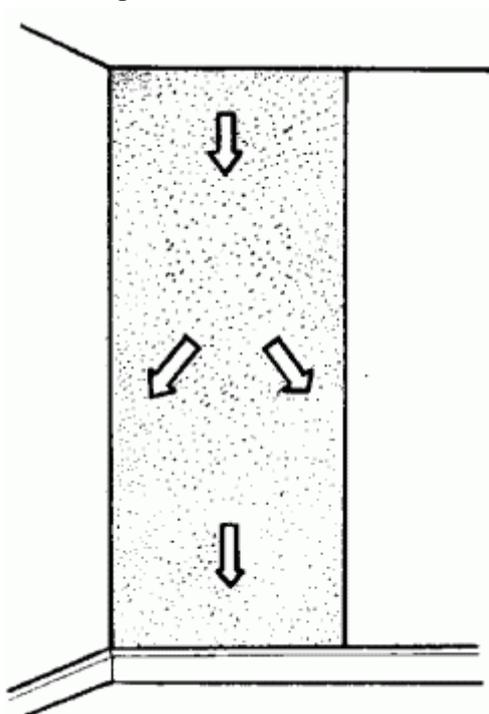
Направление разглаживающих движений тряпкой или мягкой щеткой.
